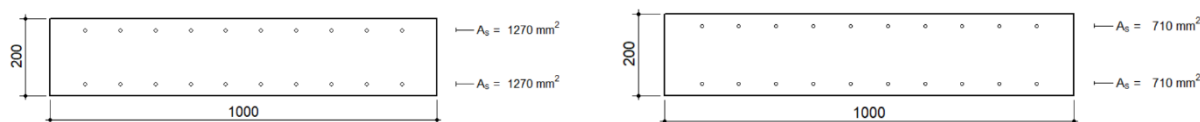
Armadura da laje na direção transversal (esq.) e longitudinal (dir.)
